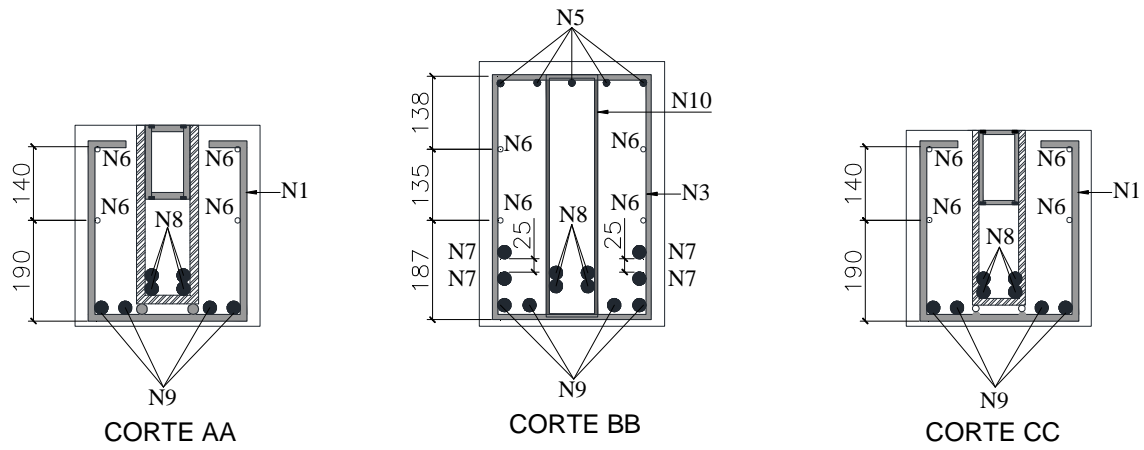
Armadura da viga pré-moldada – Parte II.
